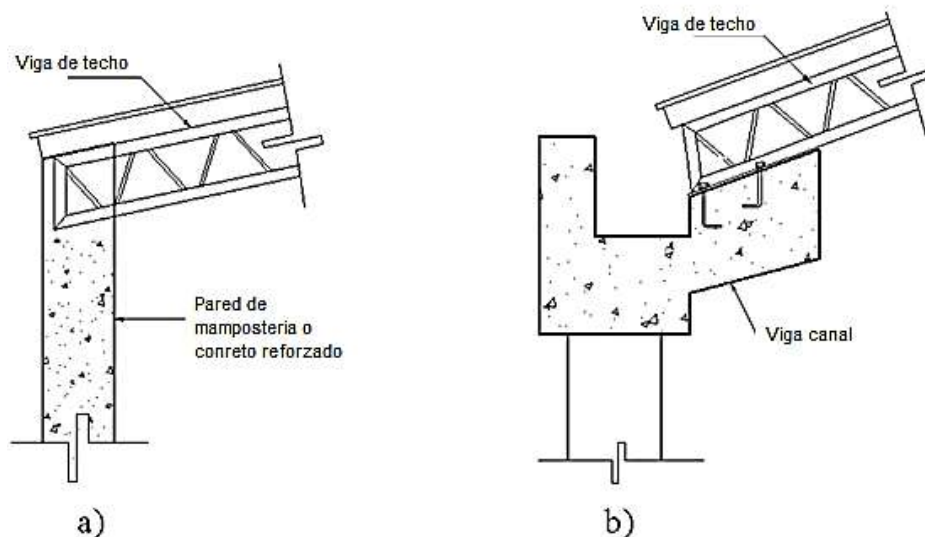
Vigas de techo embebidas en los elementos de apoyo
